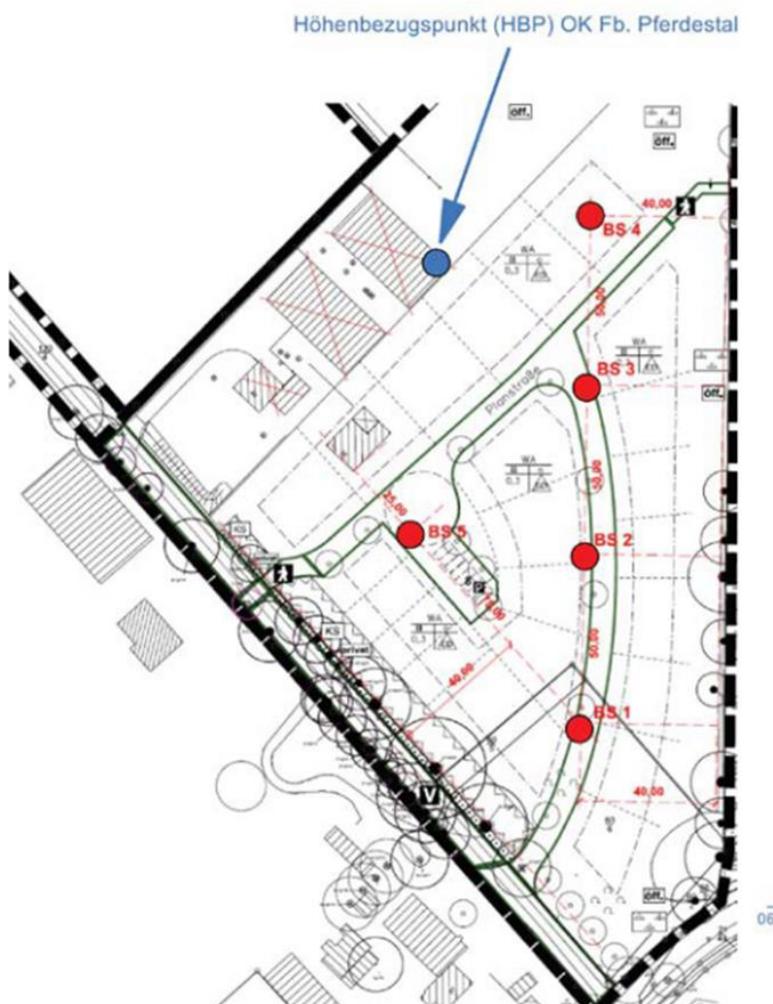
Lageplan, Bodenprofile und Lage der Bohrungen im Untersuchungsgebiet B-Plan 282 ‚Kreuzweg‘ (Geotechnisches Prüflabor, Michael Kurt 2015)
